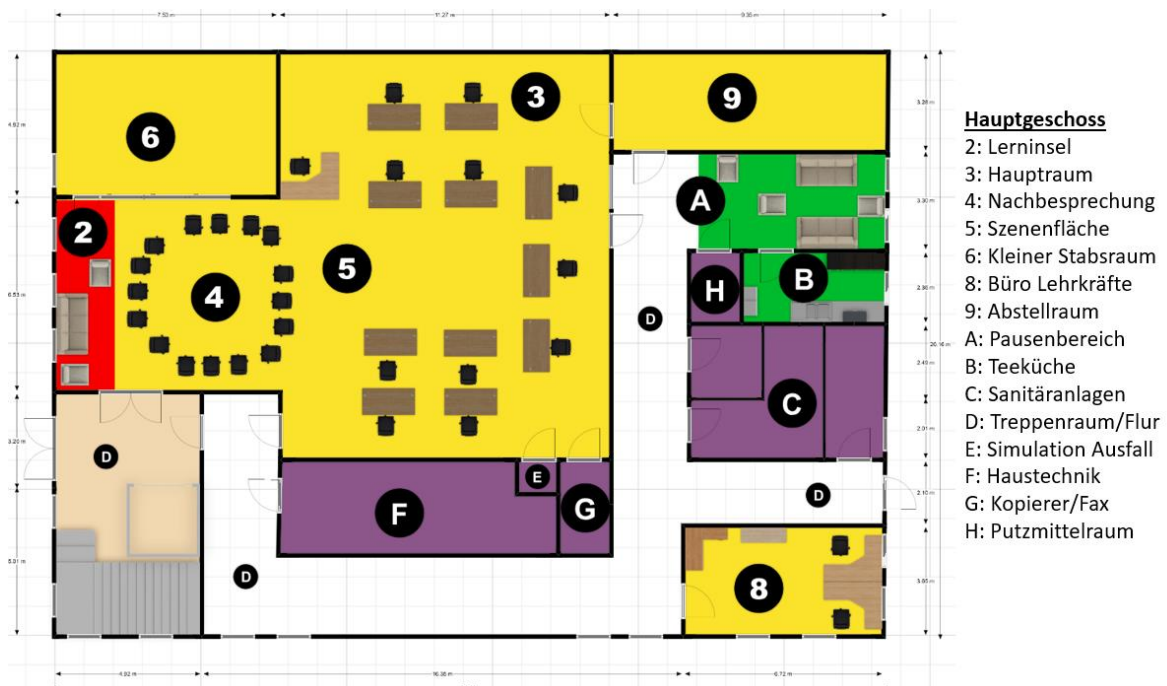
Hauptgeschoss (erstellt mit Floorplanner)
